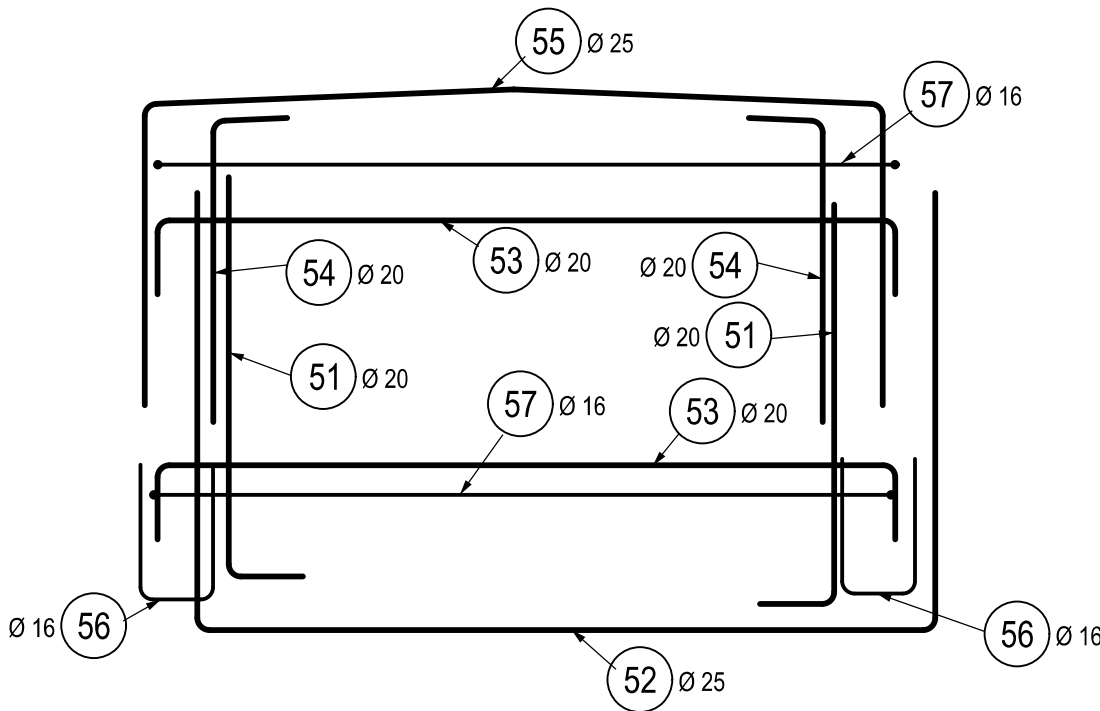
DETAIL VÝZTUŽE POD KOTVOU ZÁVĚSU, 1:25
